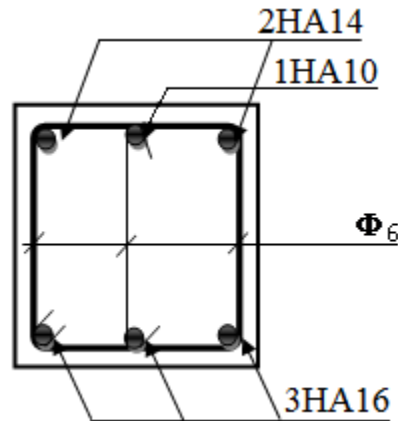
Schéma de ferrailage de la poutre de chaînage.
